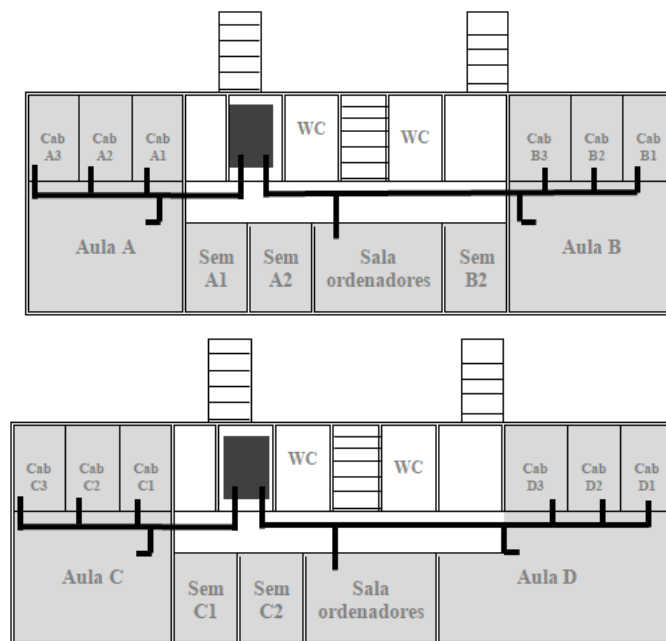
UTAs centralizadas ubicadas en los despachos planta 1 y 2.
